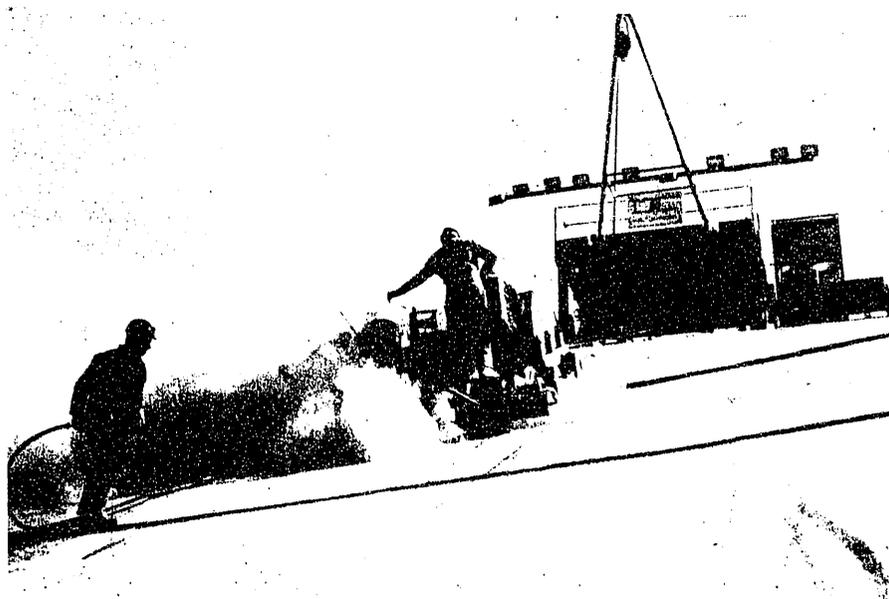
Extendido del mástic y pulverización de aluminio.
